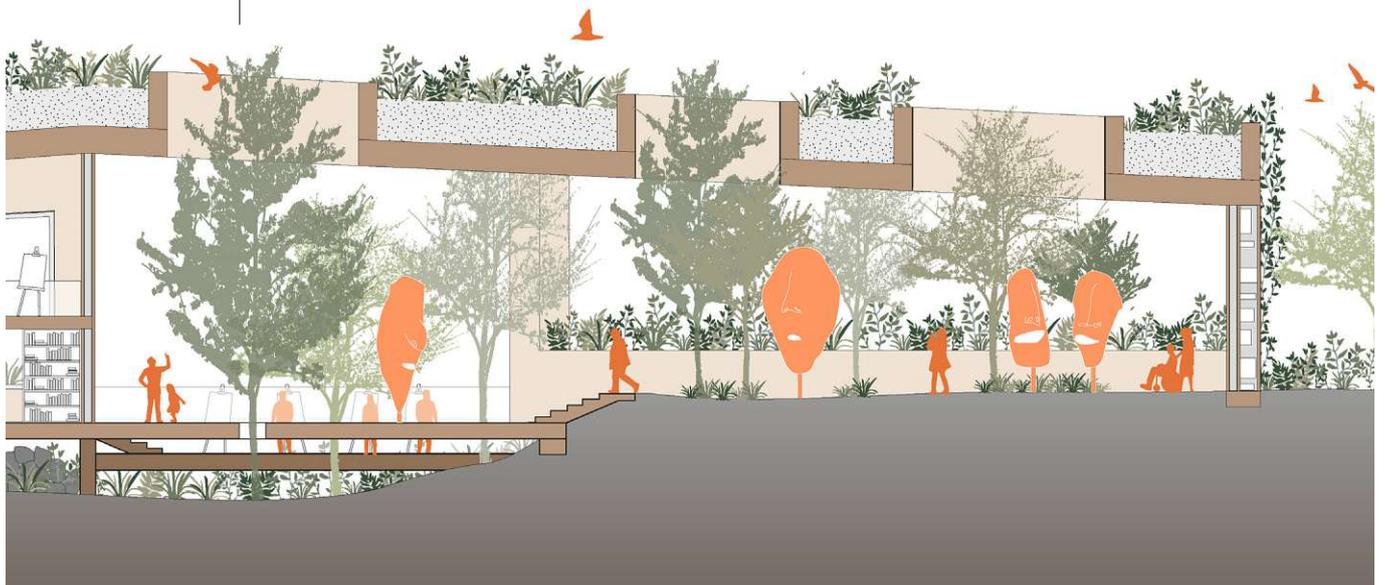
Schnitt B-B 1:200 (Tragwerksberechnung wurden nicht durchgeführt)
